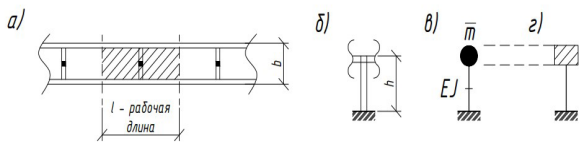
К разработке динамических расчетных схем опорных стен.
